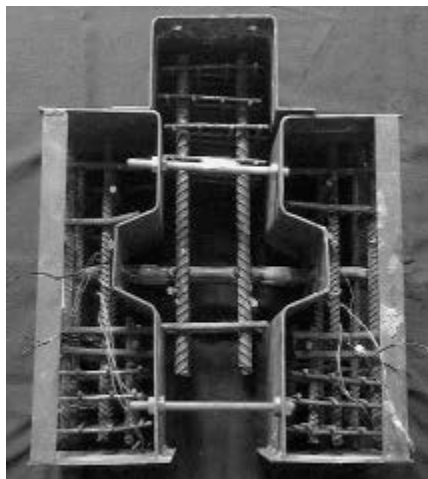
Конструкція та схеми армування фібробетонних зразків четвертої серії із розміщенням арматури:
